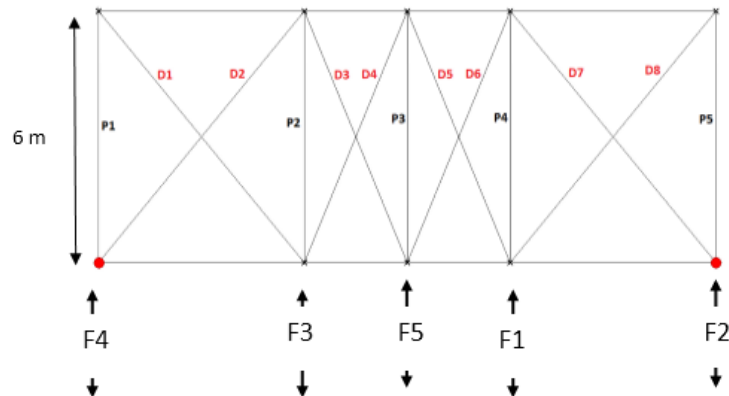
Nomination des diagonales et des pannes et les forces agissant sur la poutre au vent
